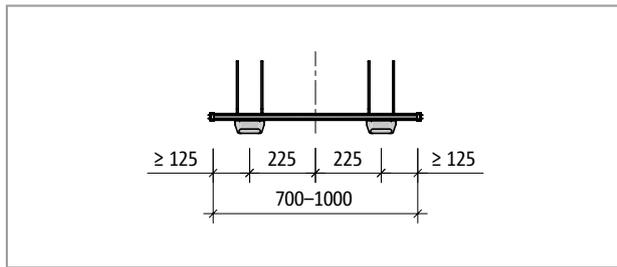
Schöck Tronsole® Typ T-V2-...-L700 bis L1000: Produktgrundriss
